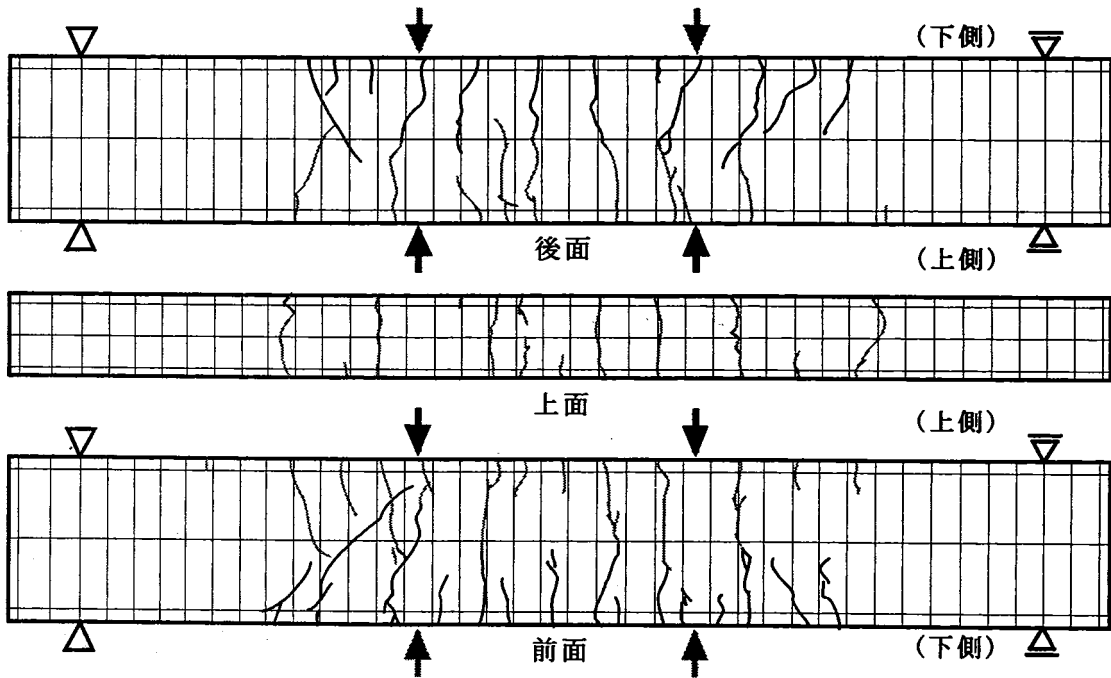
c) ひび割れ性状 [BS-3 ; R = 1/400rad.]
